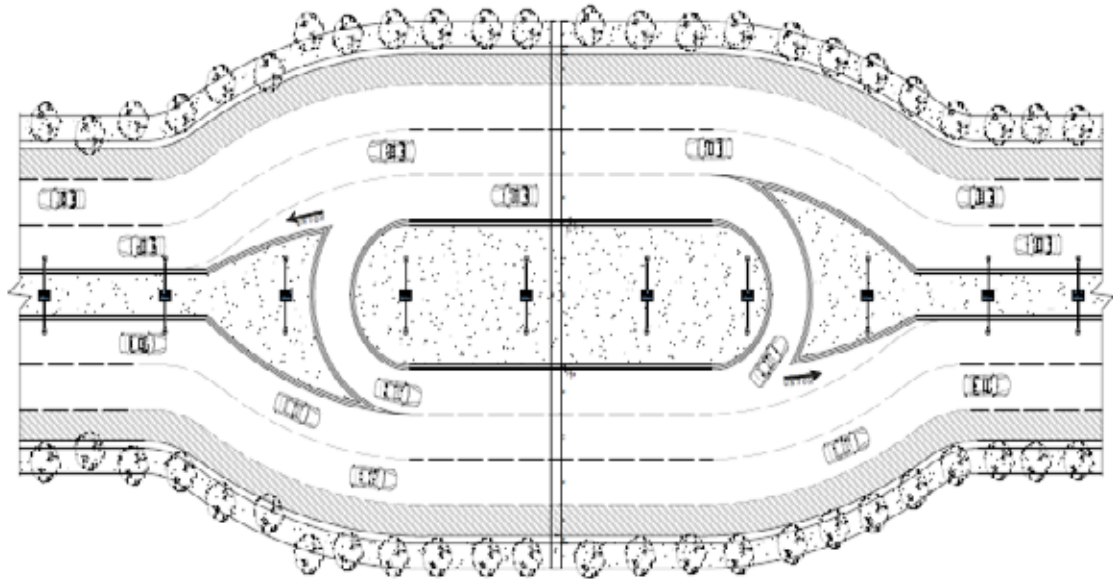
Planta de Retornos y Perfil Colector Propuestos
